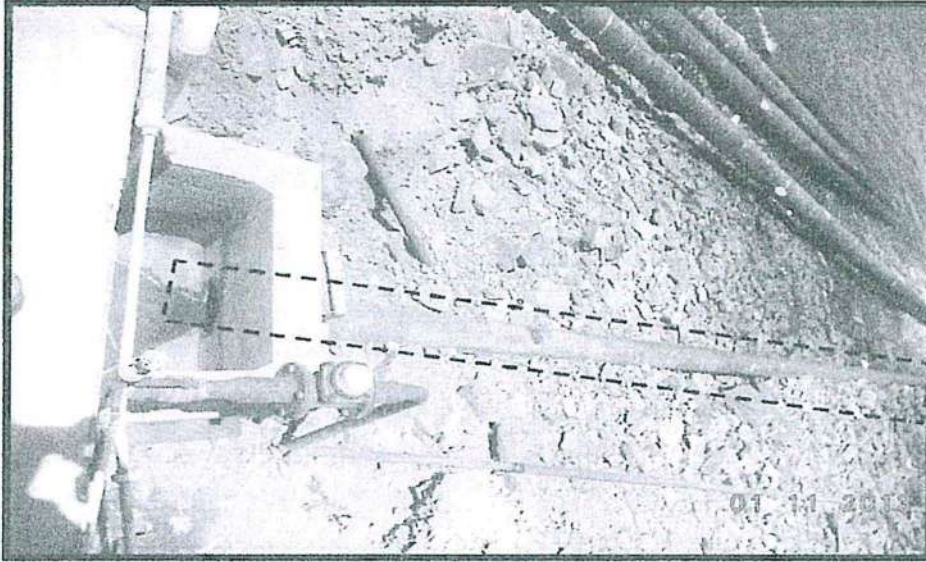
Parte final de la canaleta por la cual son vertidas las purgas de los calderos en conjunto con el agua de la columna barométrica.
